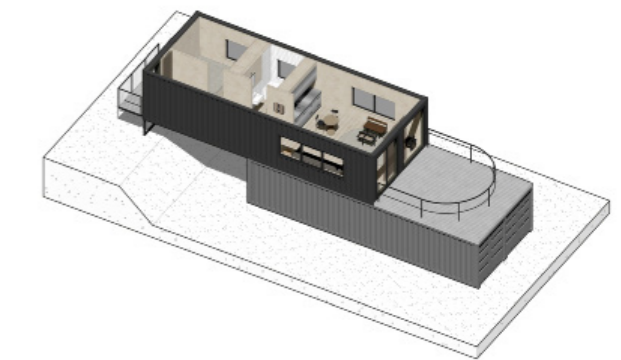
Axonometría Cabina Portátil. Fuente: Silva, V.
